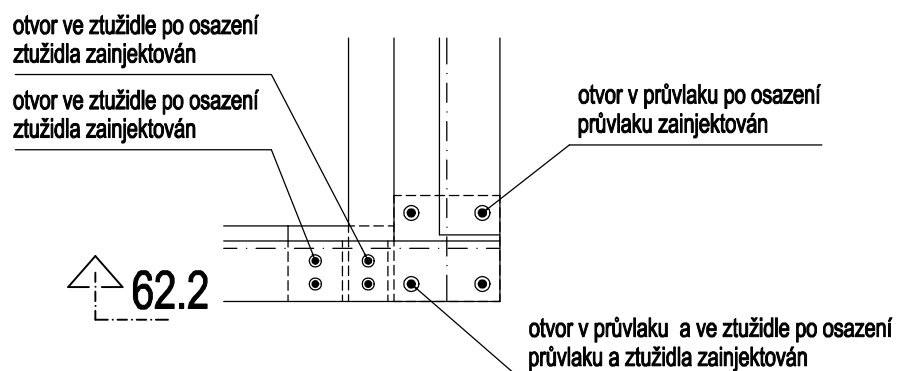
SPOJENÍ PRŮVLAKU S KRAJNÍM SLOUPEM A STĚNOVÝM ZTUŽIDLEM (PŘEKLADEM)
